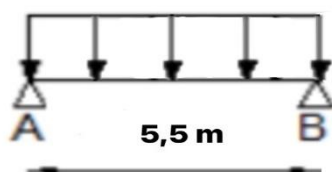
Schéma statique de la poutre reposant sur deux appuis.
